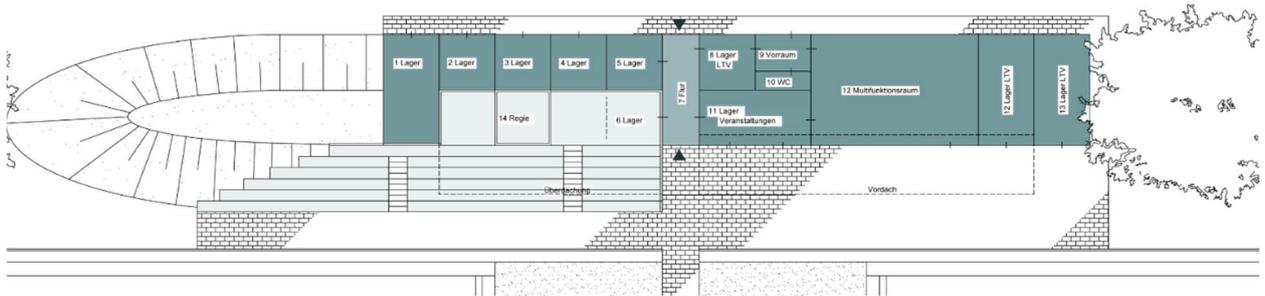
Grundriss eines in die Tribüne integrierten Gebäudes
